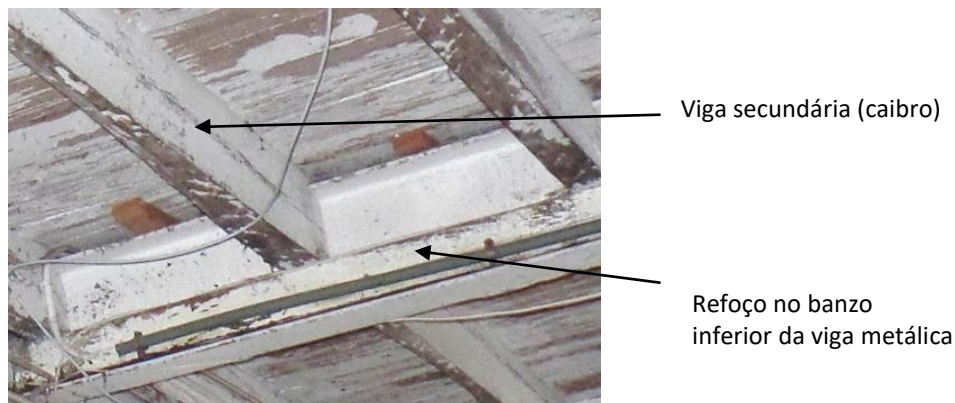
Pavimento no edifício base (vigas metálicas e caibros).
